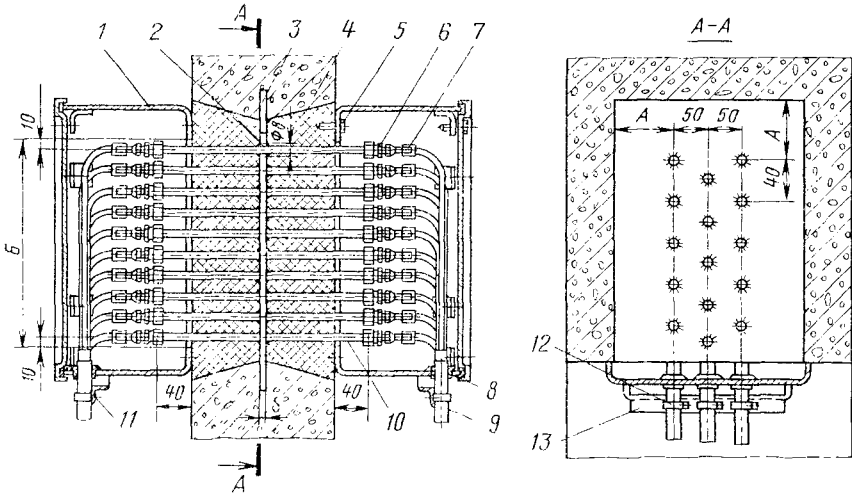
Конструкции прохода пневмокабелей через стены и перекрытия взрыво- и пожароопасных помещений с пределом огнестойкости 1 ч и более:
